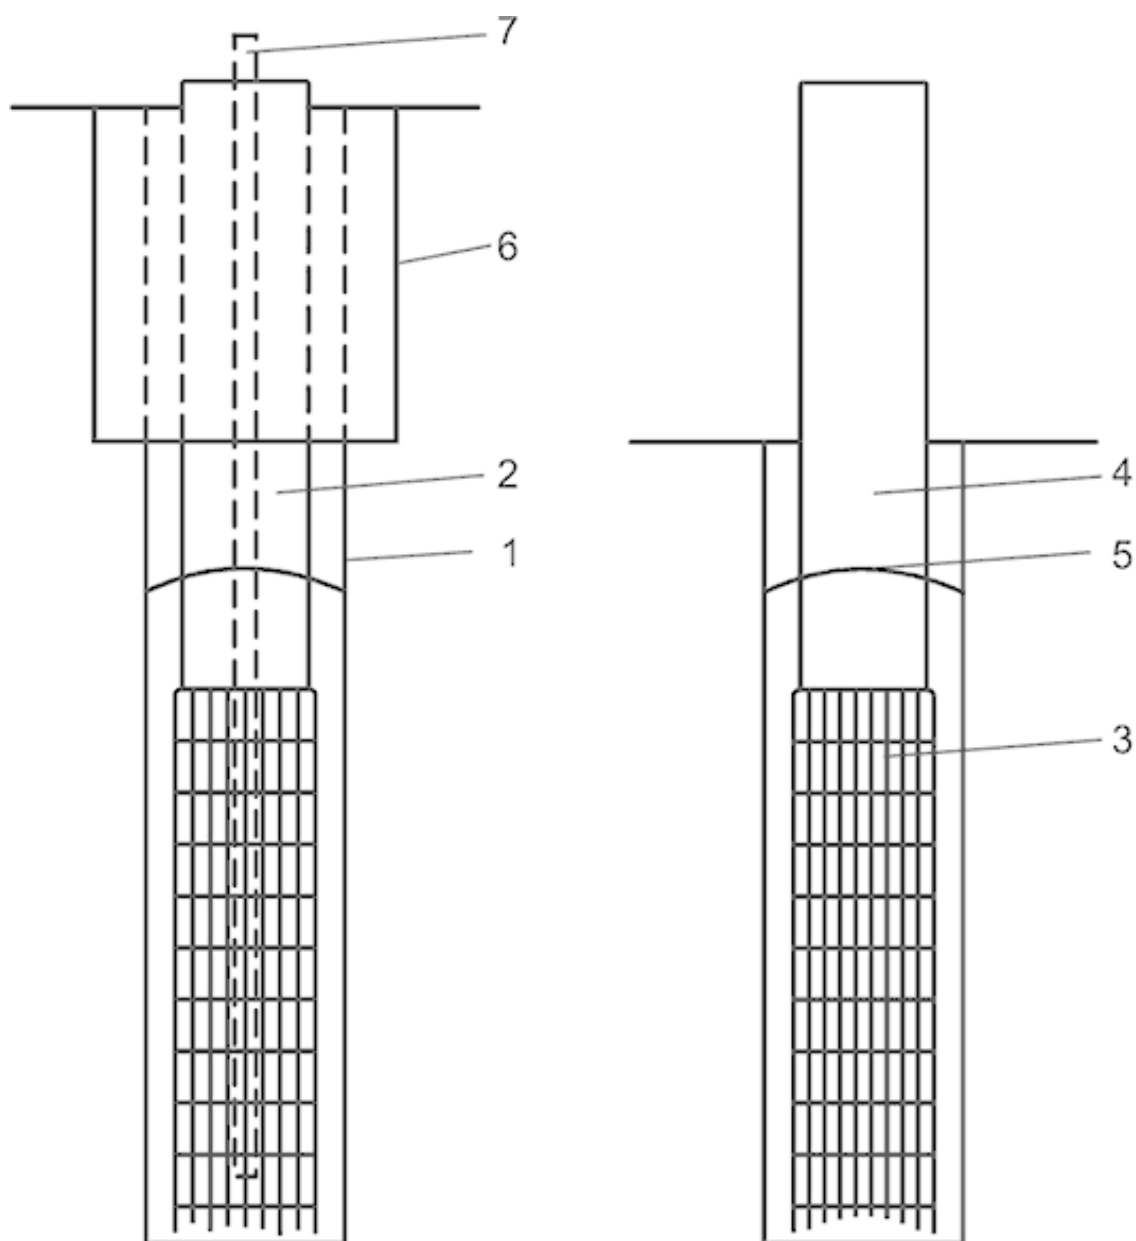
Пример выполнения опоры, где указаны скважина 1, трубно-арматурный каркас 2 с арматурной частью 3 и трубной частью 4, ограничитель 5 уровня заполнения скважины бетонной смесью, кондуктор 6, бетонолитная труба 7
